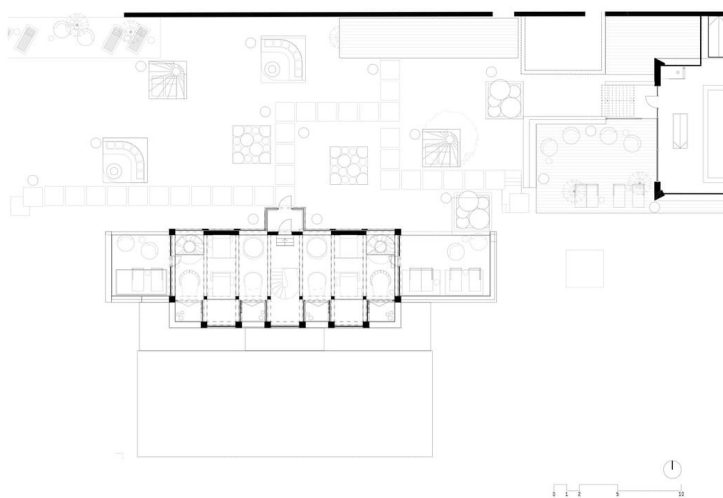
План 1-го этажа SPA-комплекса MOHR escape
